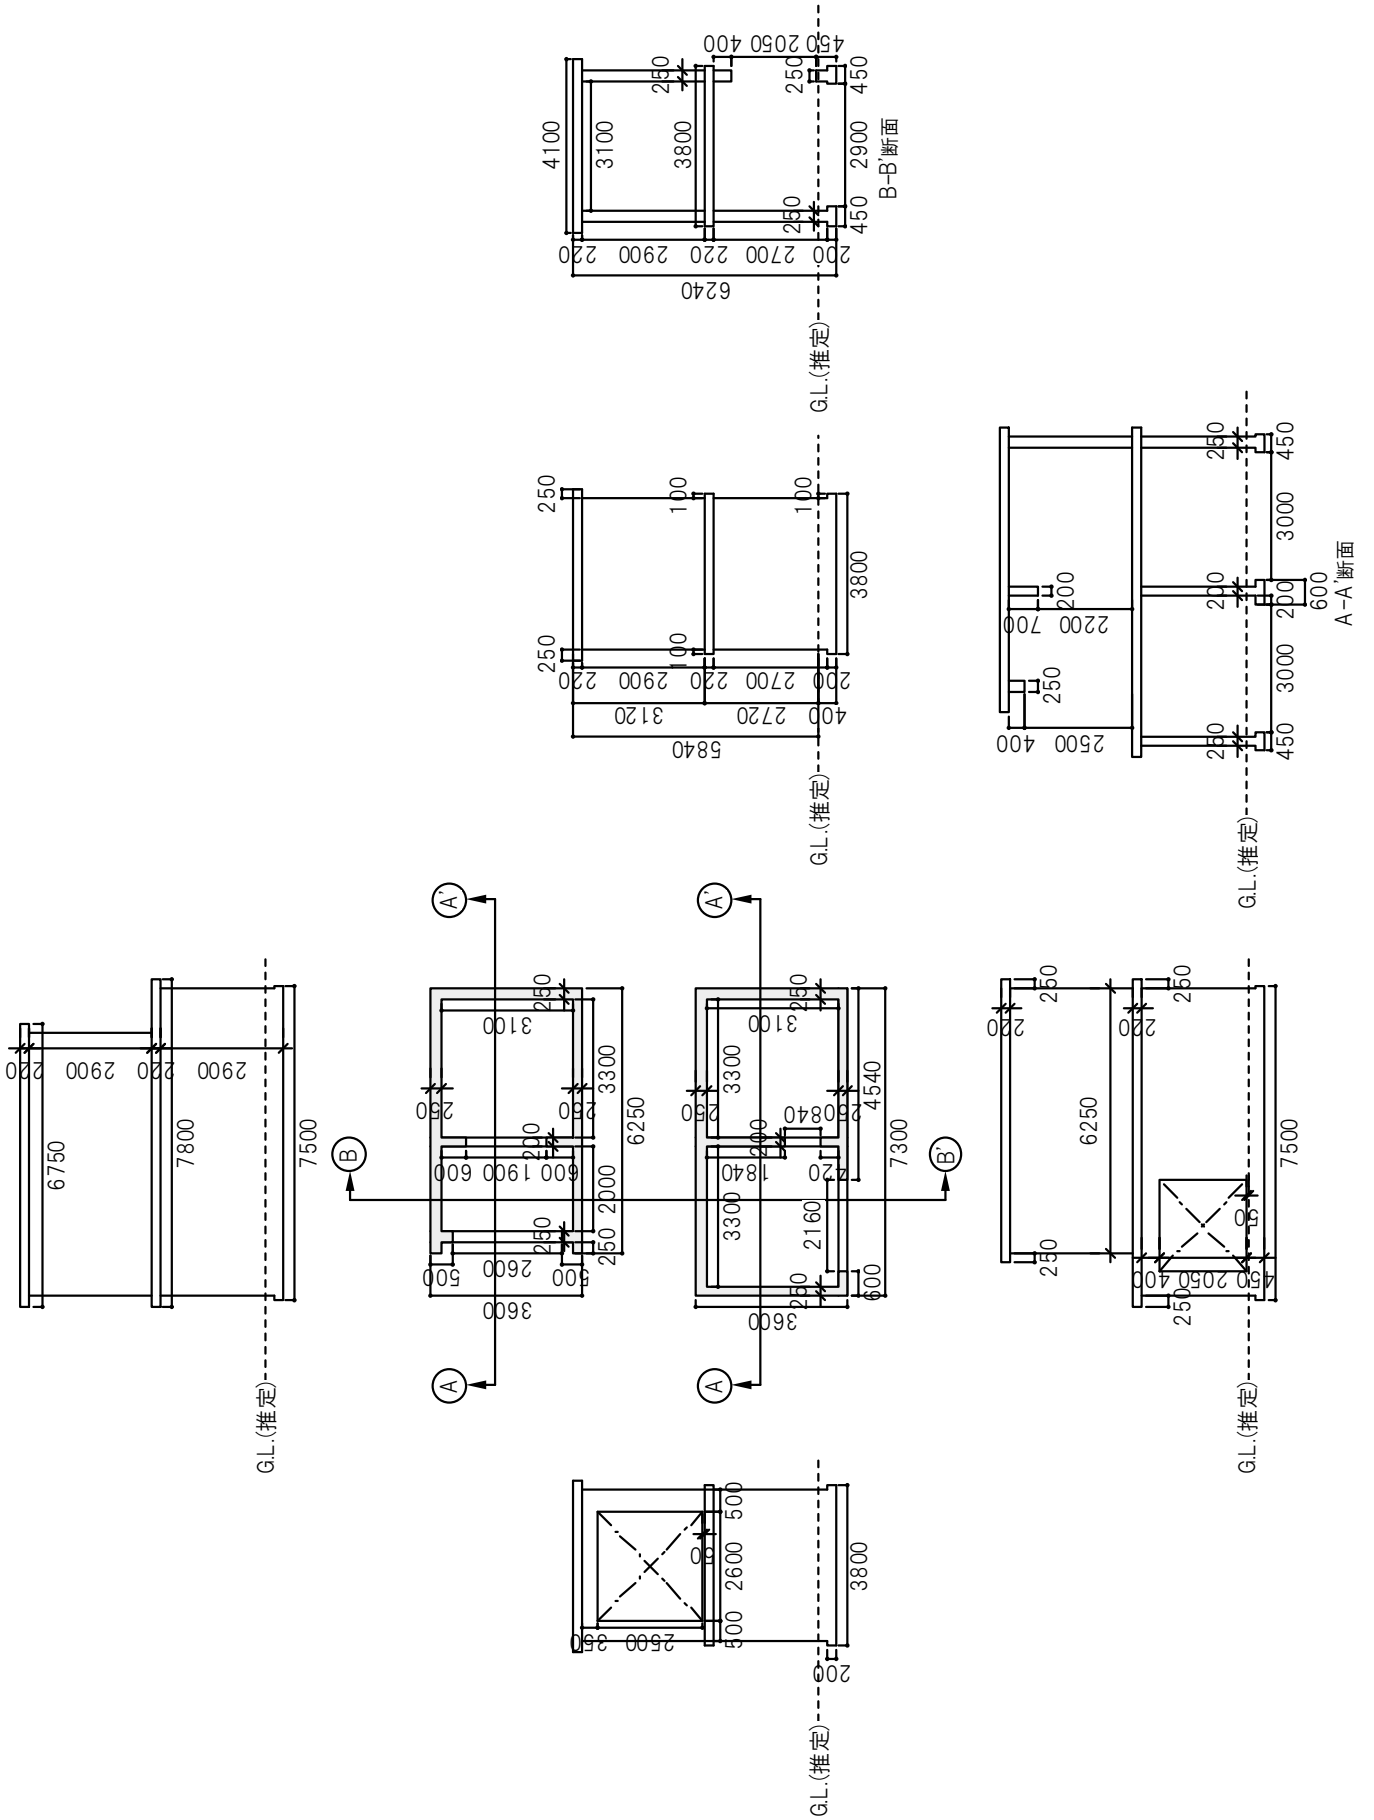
RC造壁式2階建て住宅の立面図・平面図 (単位: mm)
